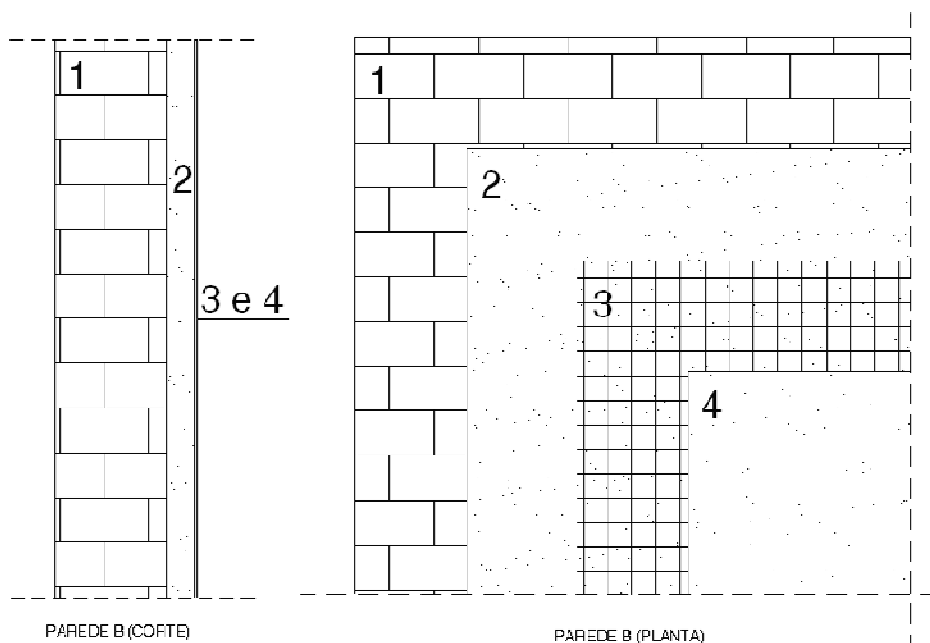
Esquema demonstrativo da constituição do provete (Parede B em corte e planta).
